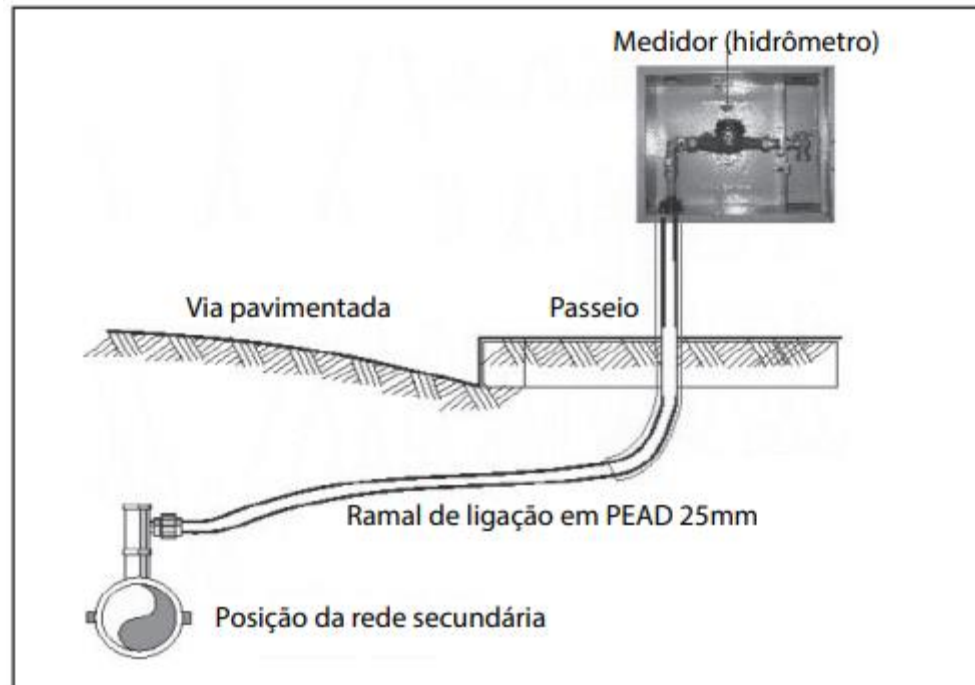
Vista, em corte, da ligação instalada (Fonte: Parente e Silva,2016).
